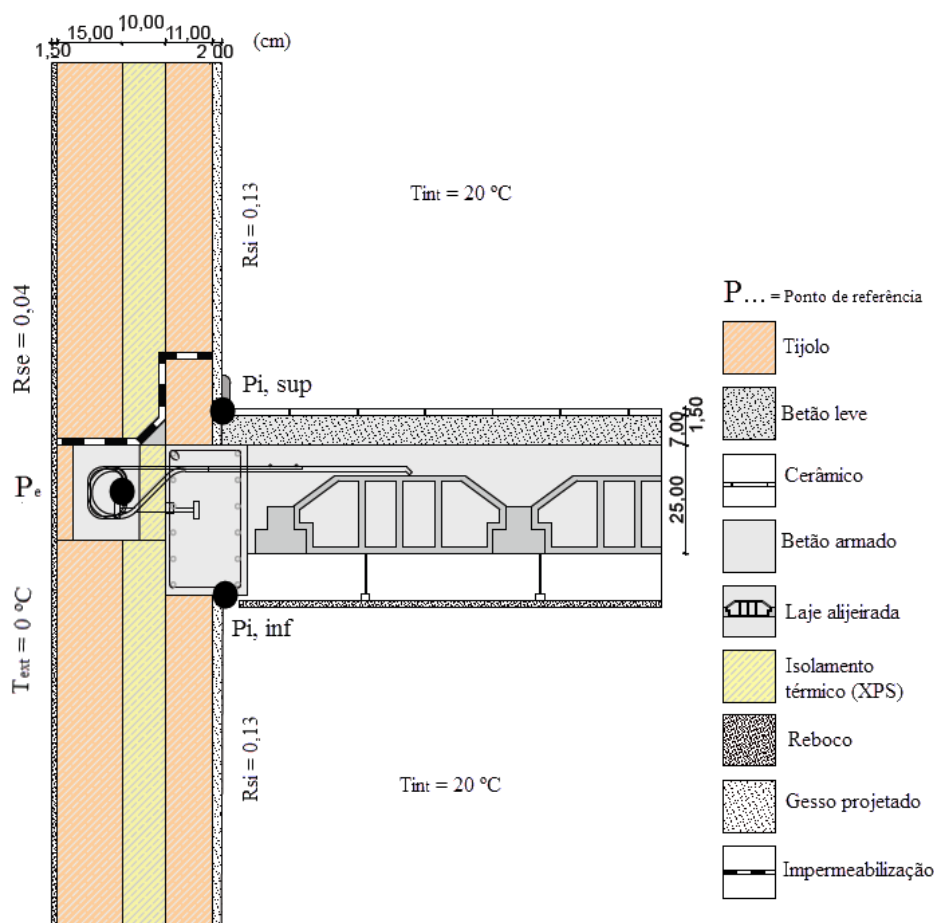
Ligação de fachada (parede dupla) com pavimentos intermédios
